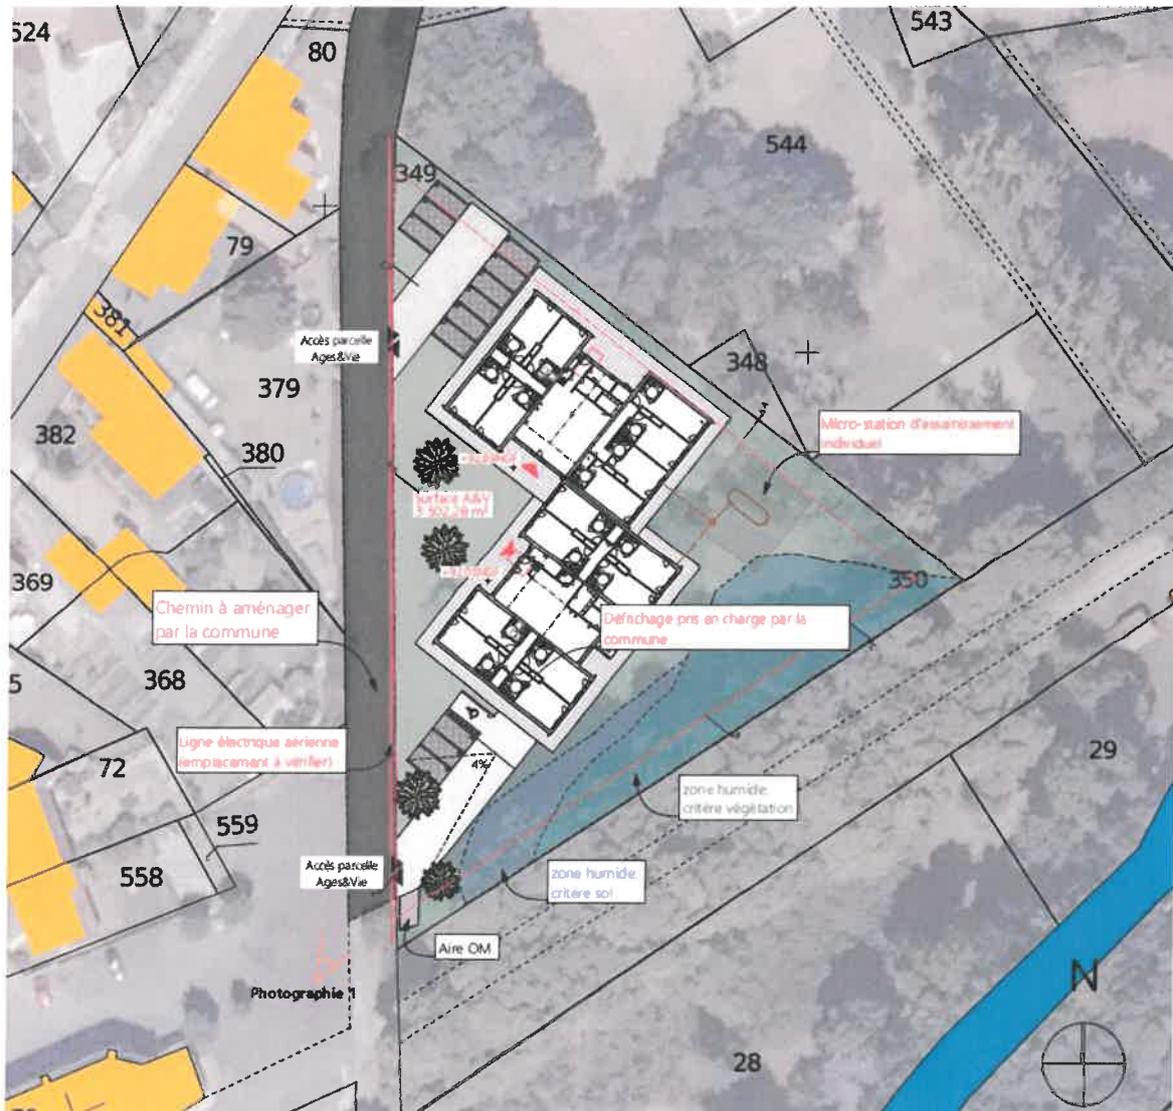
Plan masse du projet de colocation pour seniors (Ages et Vie)
